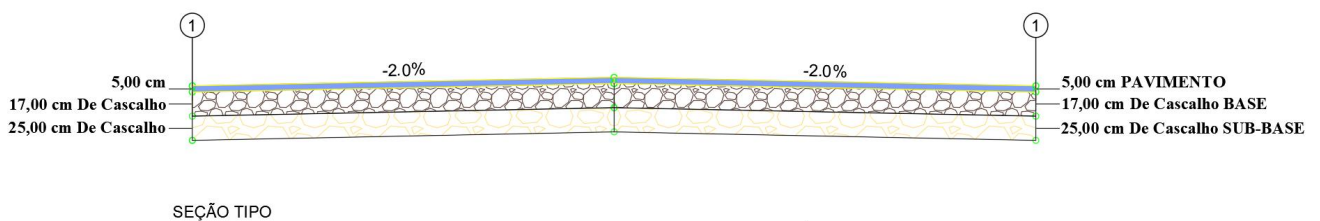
Espessuras de Camadas adotado em Projeto | Fonte: O autor, 2024.
